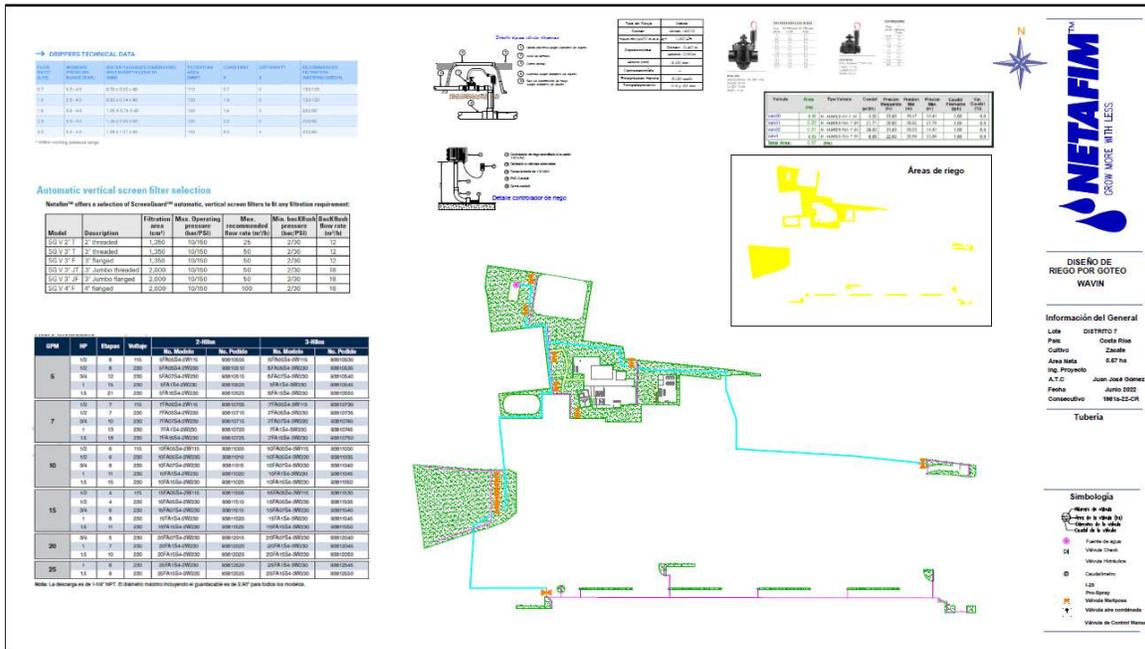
Sistema de Riego para Reúso de Planta de Tratamiento. Lamina Constructiva sin número.
